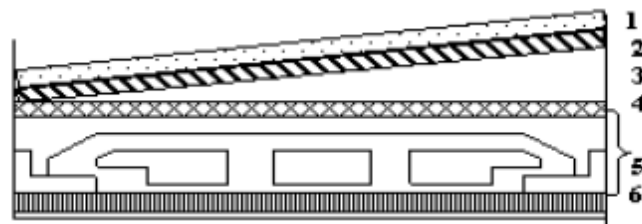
Section transversale d'un plancher (terrasse inaccessible).
